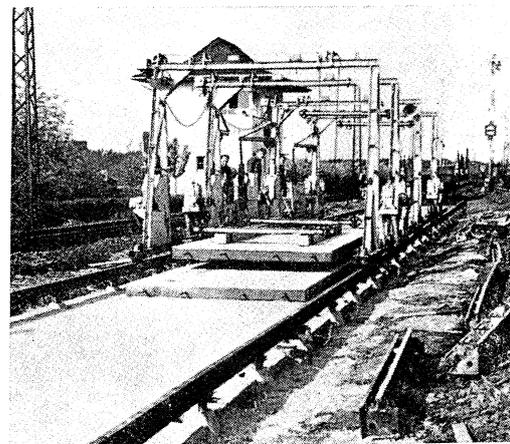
Colocación de las placas de hormigón pretensado para la consolidación de la vía sobre el hormigón ligero de Styropor. (fig. 24).
